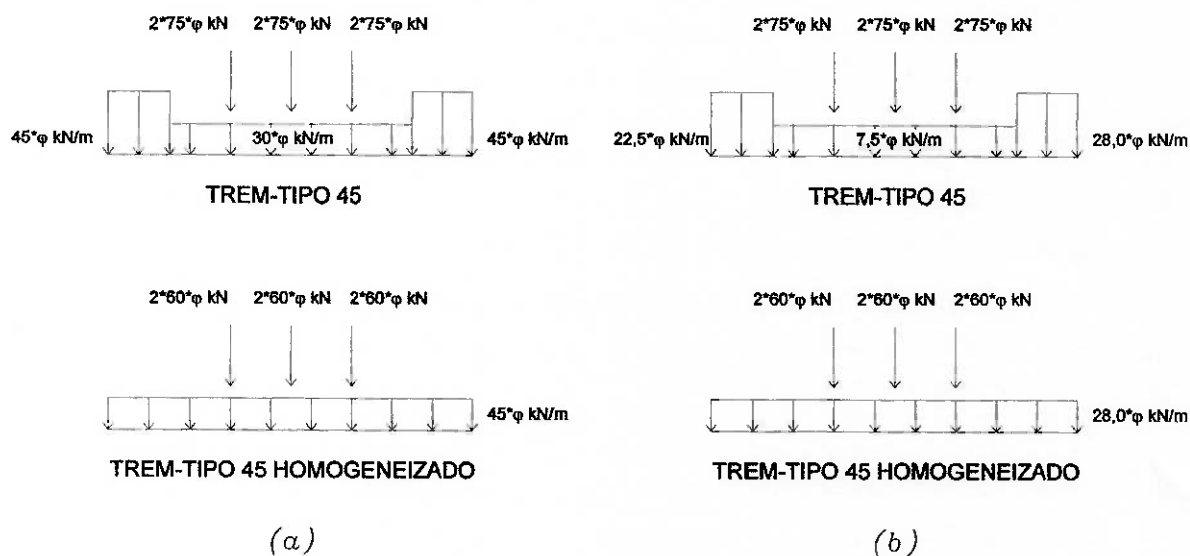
Cargas Longitudinais do TT-45 para (a) tabuleiro todo carregado e (b) tabuleiro meio carregado
